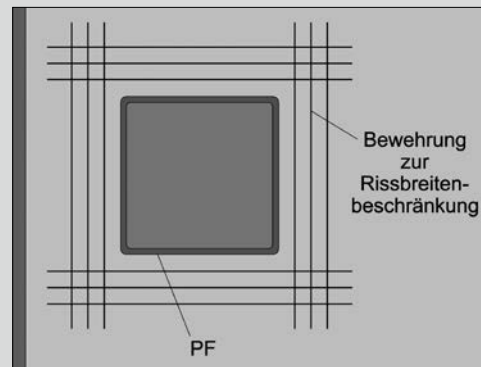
Beispiel einer rissbreitenbeschränkenden Bewehrung an einem Straßenablauf in künftiger Betonfläche
